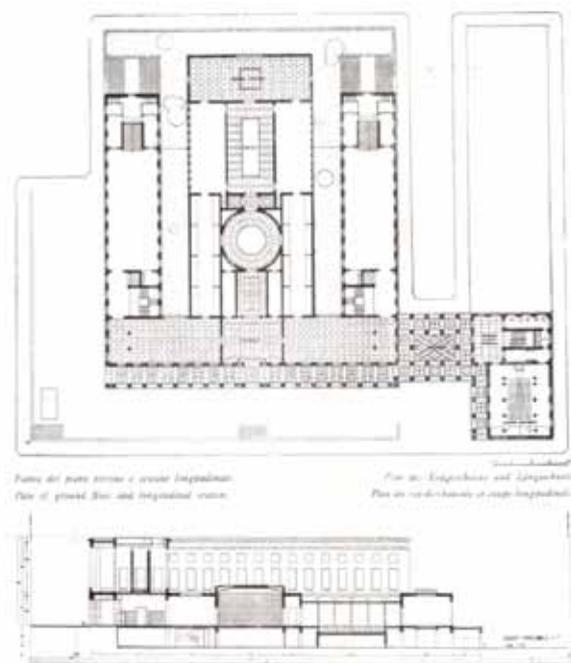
Il Museo di Arte Moderna, pianta del p.t. e sezione (da Architettura, 1938, numero speciale).
